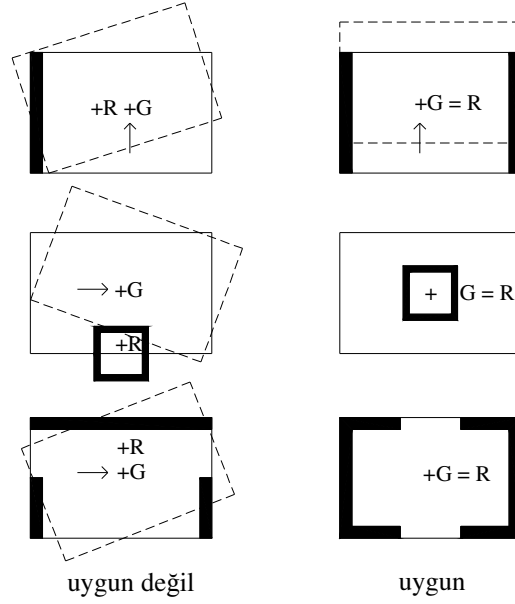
Yatay yük altında yapının plandaki davranışı
